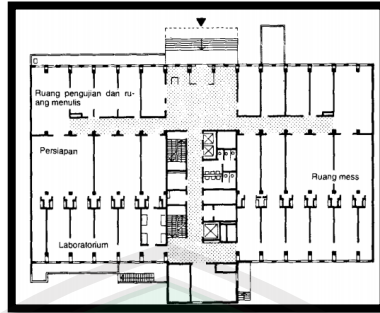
Laboratorium Bahan Bangunan Universitas Gadjah Mada
